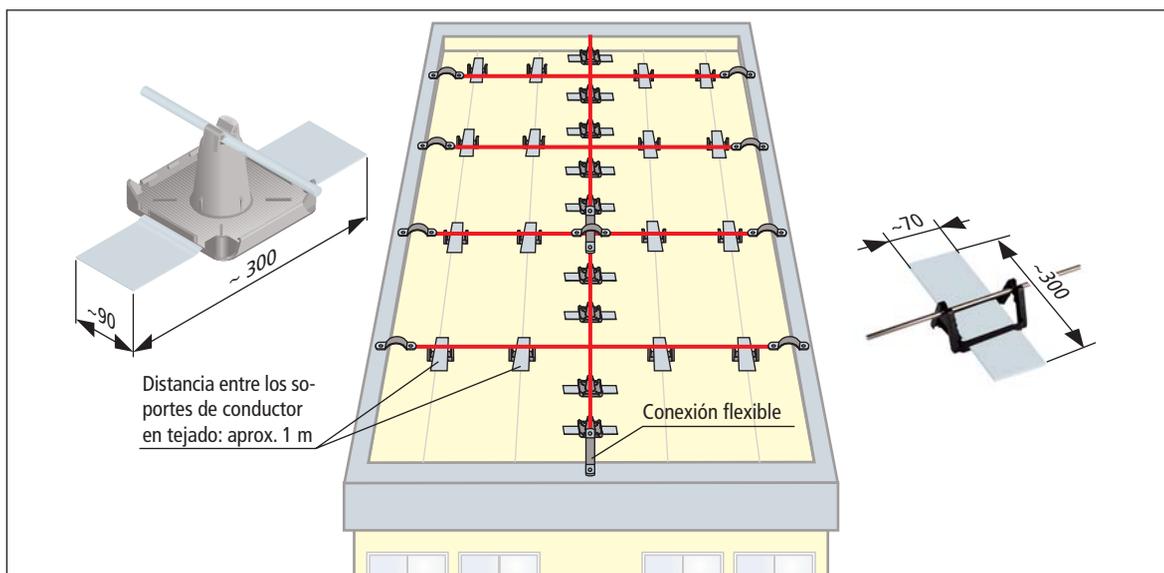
Bandas para tejado plano sintético. Soporte de conductor de tejado tipo KF/KF2.
